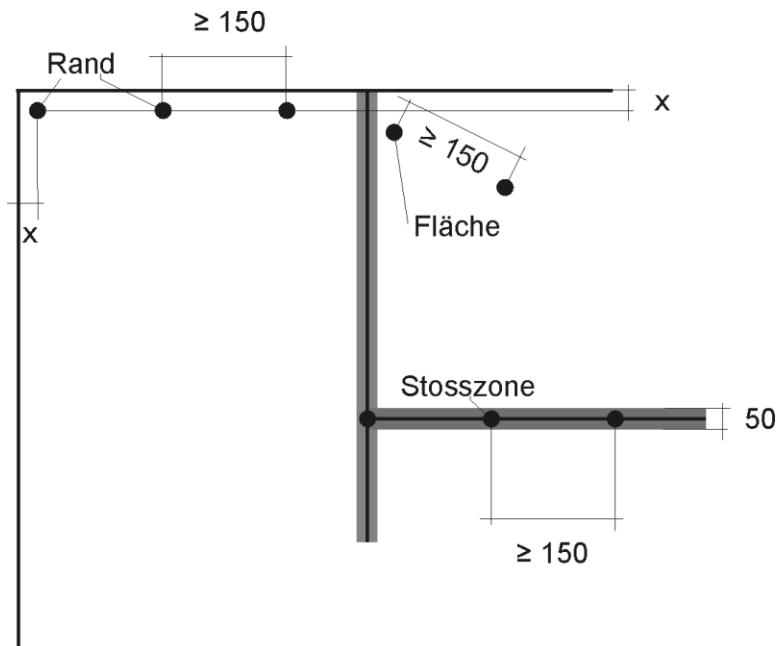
Beschussorte des Sandwichelements im Grundriss (Masse in Millimeter, $x = 1/5$ Projektildurchmesser)
